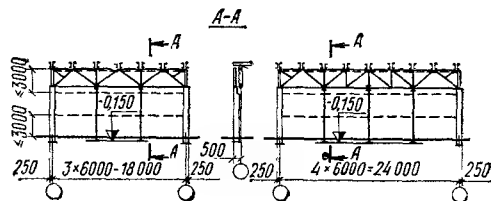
Схема стоек торцевого фахверка при покрытии со стропильными фермами из труб
